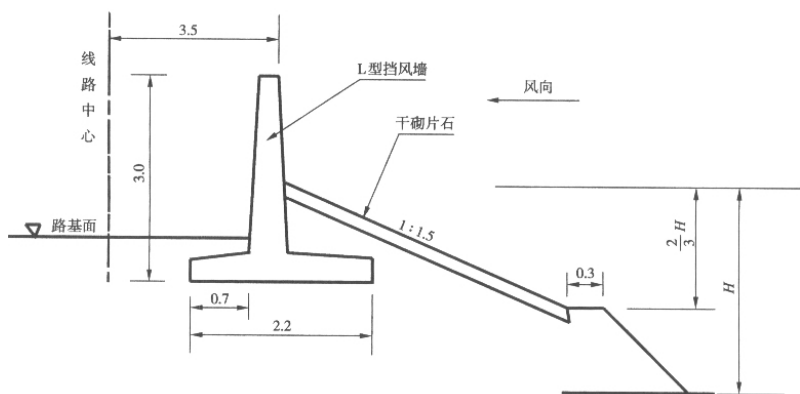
1—16 钢筋混凝土 L 型挡风墙 (尺寸单位: m)
